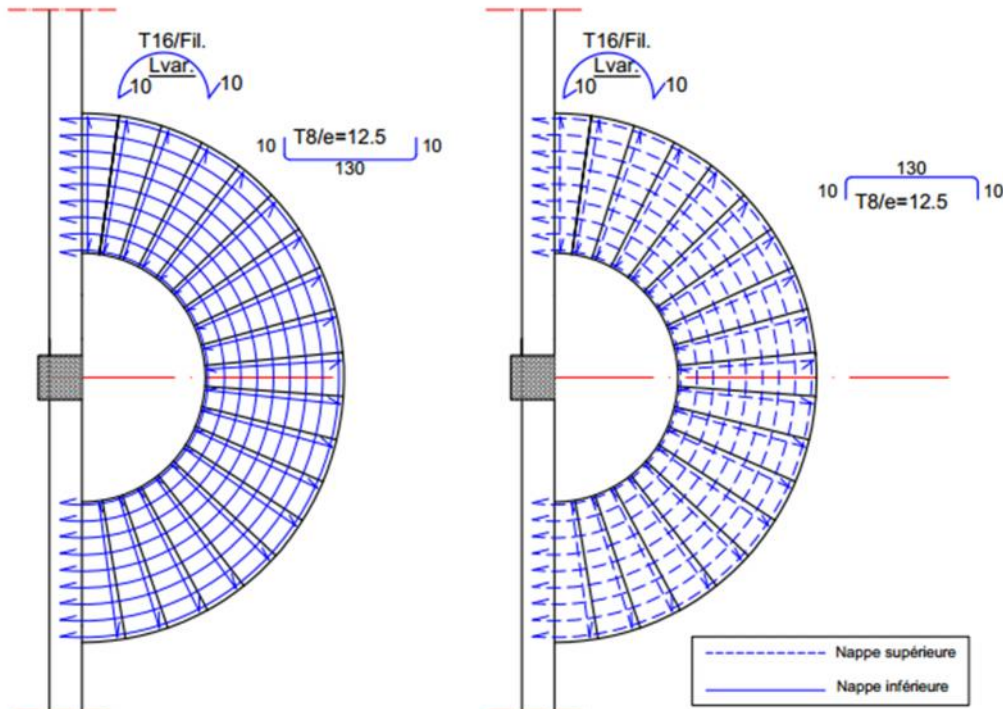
coupe transversale du ferrailage de l'escalier hélicoïdal.
